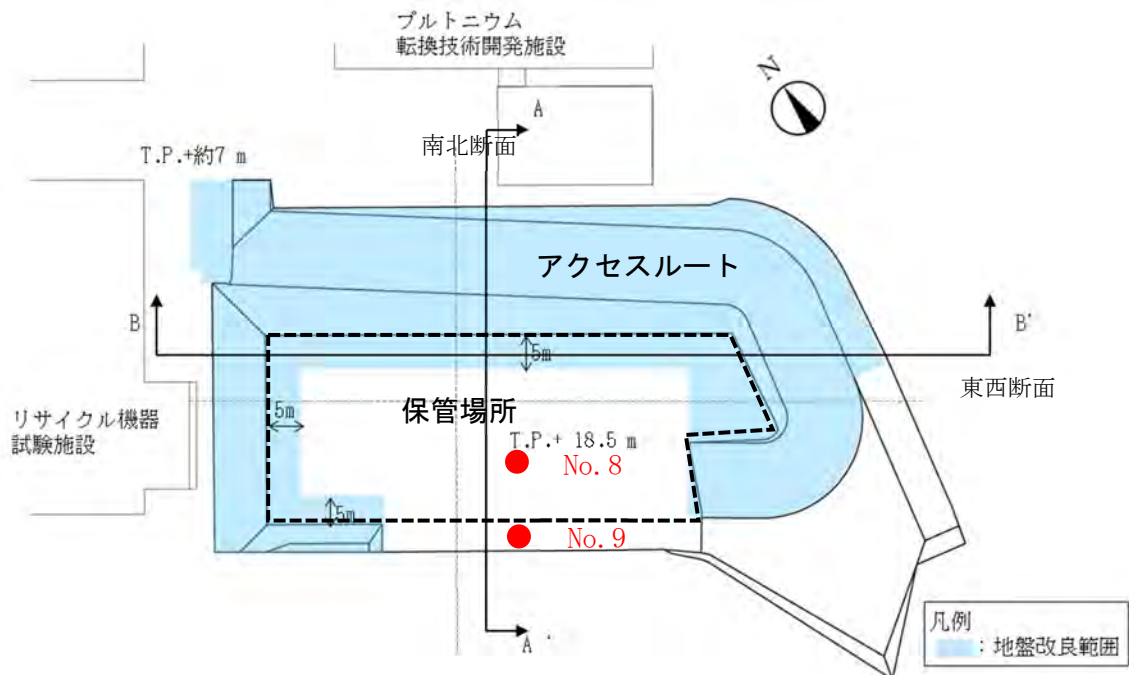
地盤改良範囲の平面図(図中赤丸印はボーリング調査位置を示す。)
